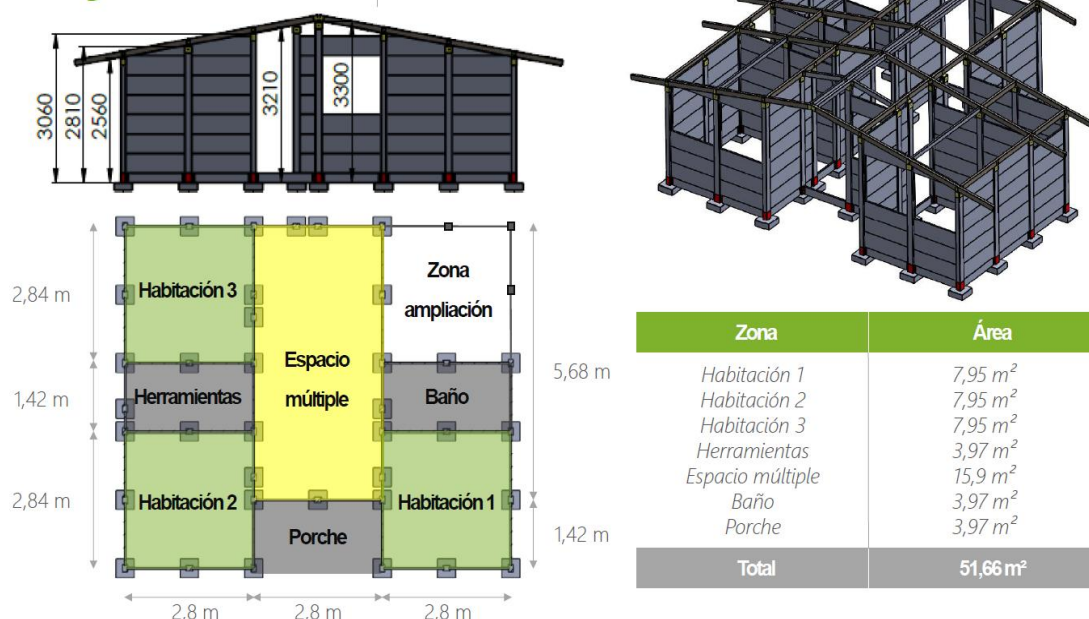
“Proyecto Vivir” modular, flexible y deconstruible “. Fuente: PREMOLDEADOS SAS, 2024
